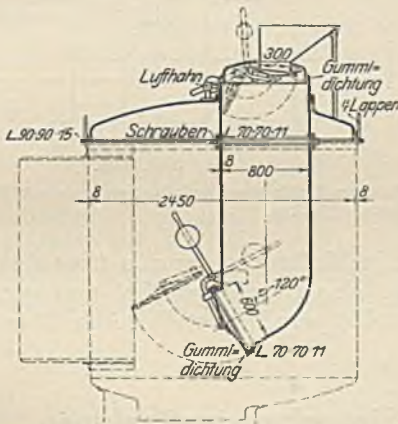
Deckel zur Schleuse mit Betonförderhose.
